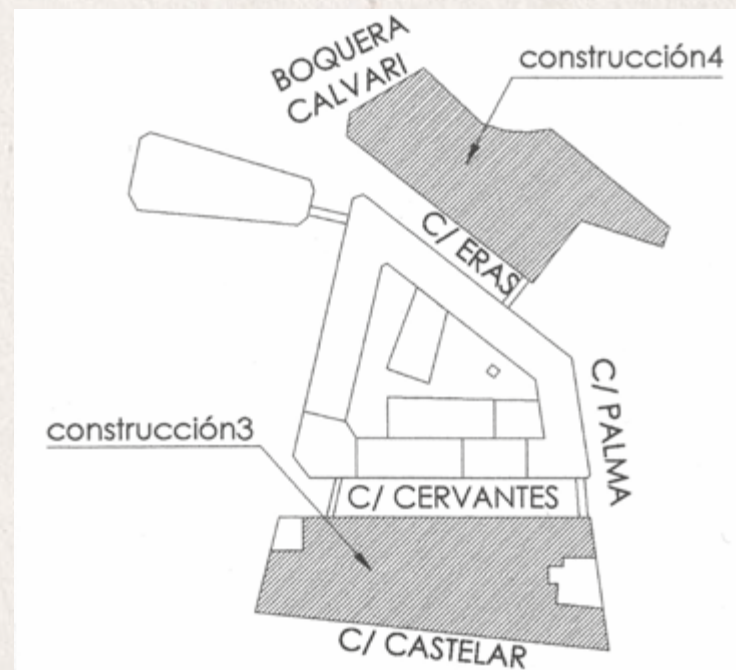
Nuevas construcciones edificadas en la fase 3 (1960-1970). Plano de Irene Moreno.
